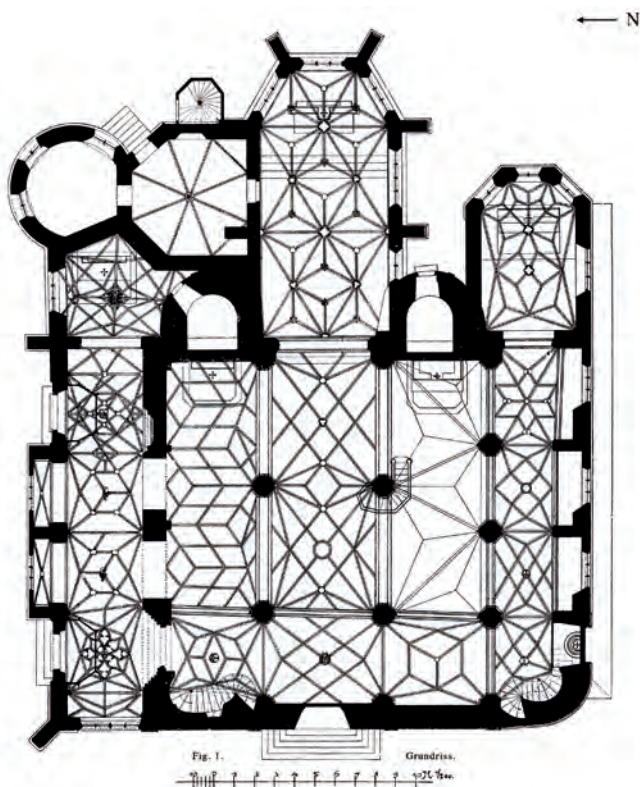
Grundriss der St Leonhardkirche. [WOLFF, JUNG1896]
